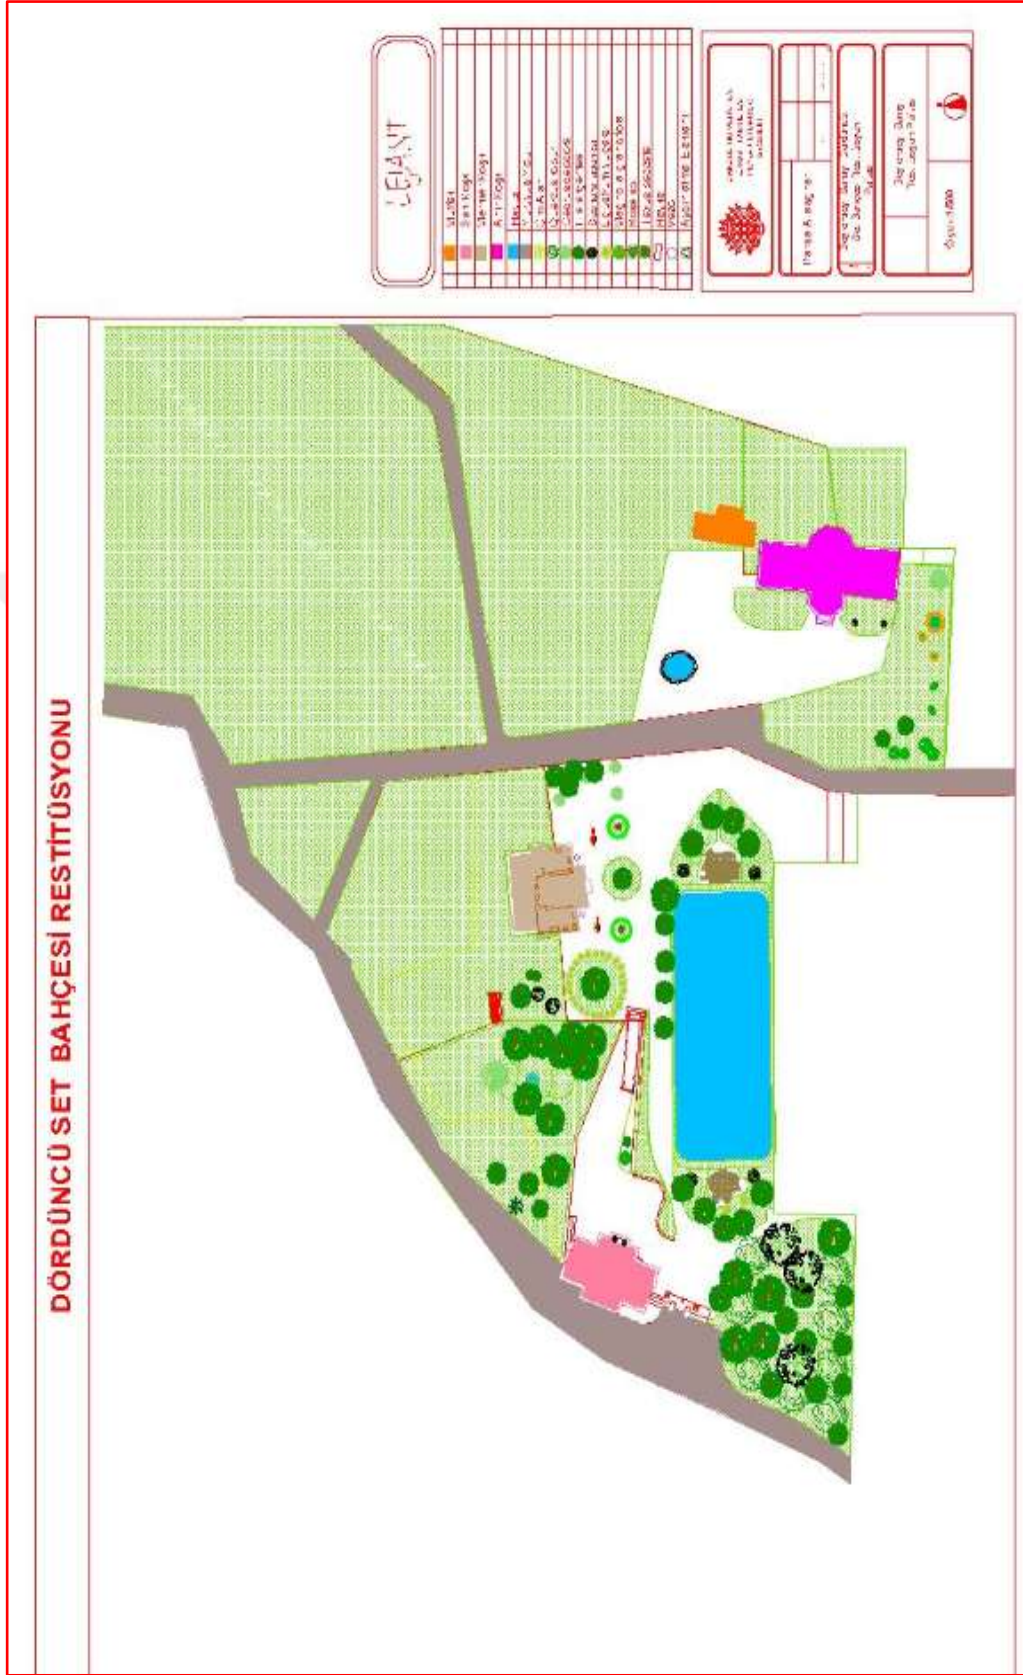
Dördüncü Set bahçesi 1960 yılı yerleşim planı (Orijinal 2016)
